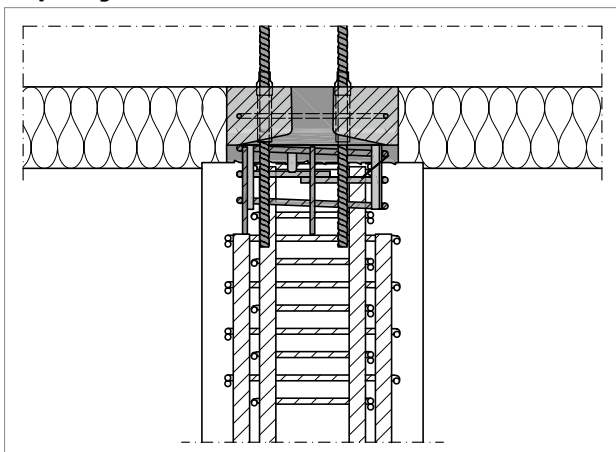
Schöck Sconnex® type P: Wapening in zone 1 - lengteprofiel van de kolom
